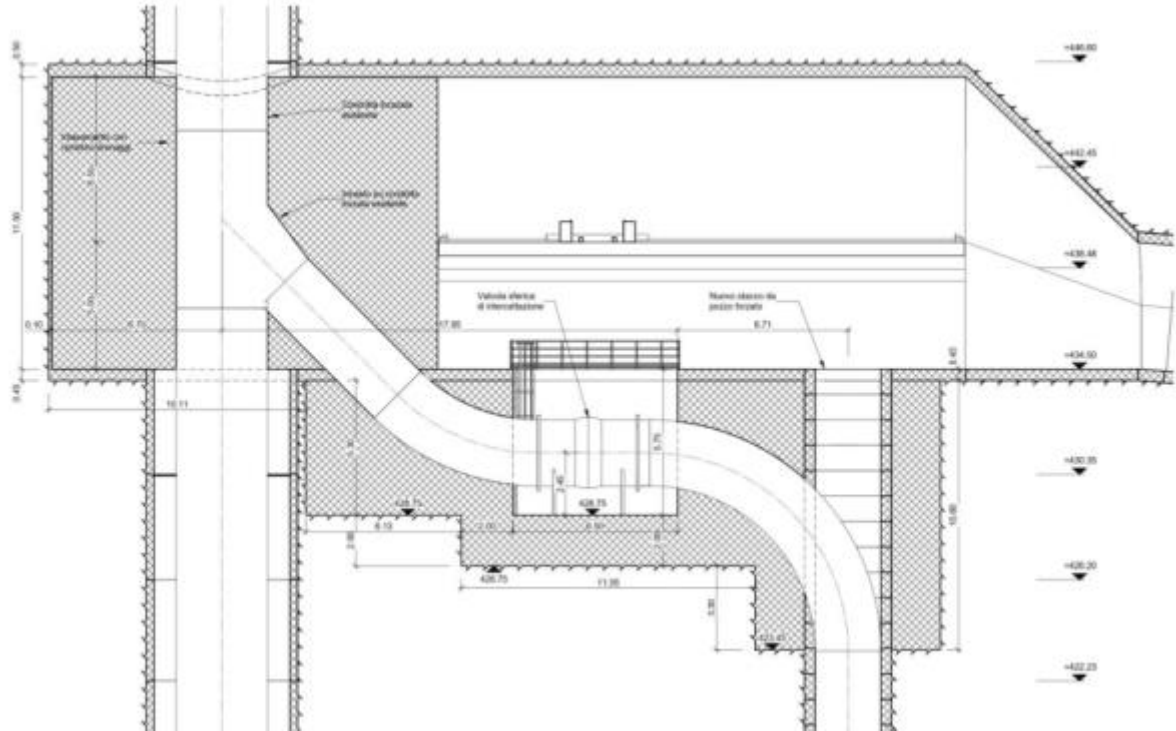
Caverna per la realizzazione del nuovo innesto sul pozzo verticale – profilo
